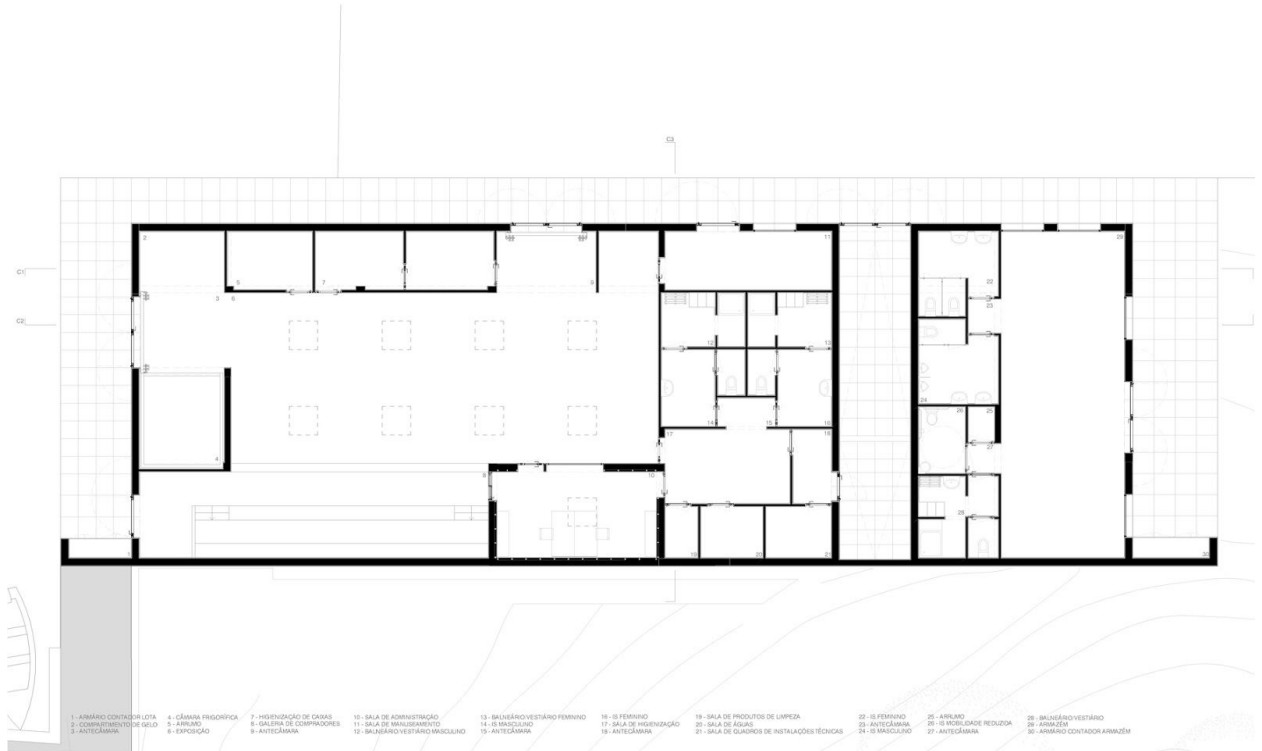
Planta da lota do portinho de Castelo de Neiva.
